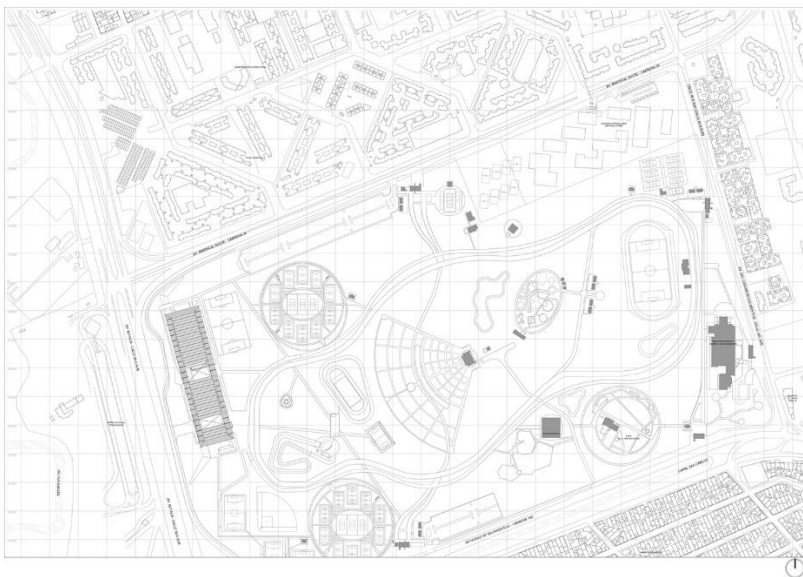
Planta del Centro Deportivo, Recreativo y Cultural del Parque, Extraída de archdaily.
